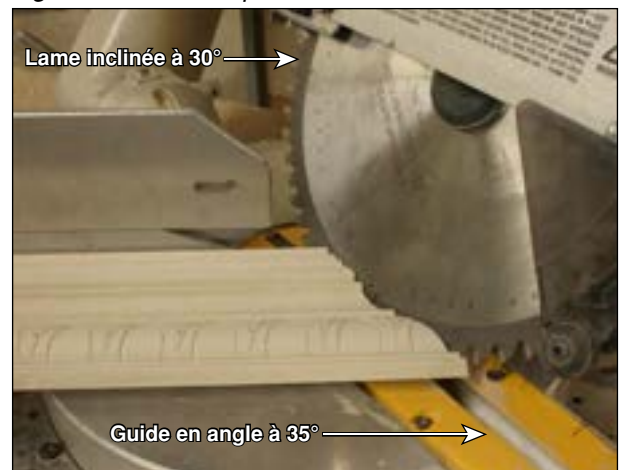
Exemple d'assemblage de moulures de corniche
